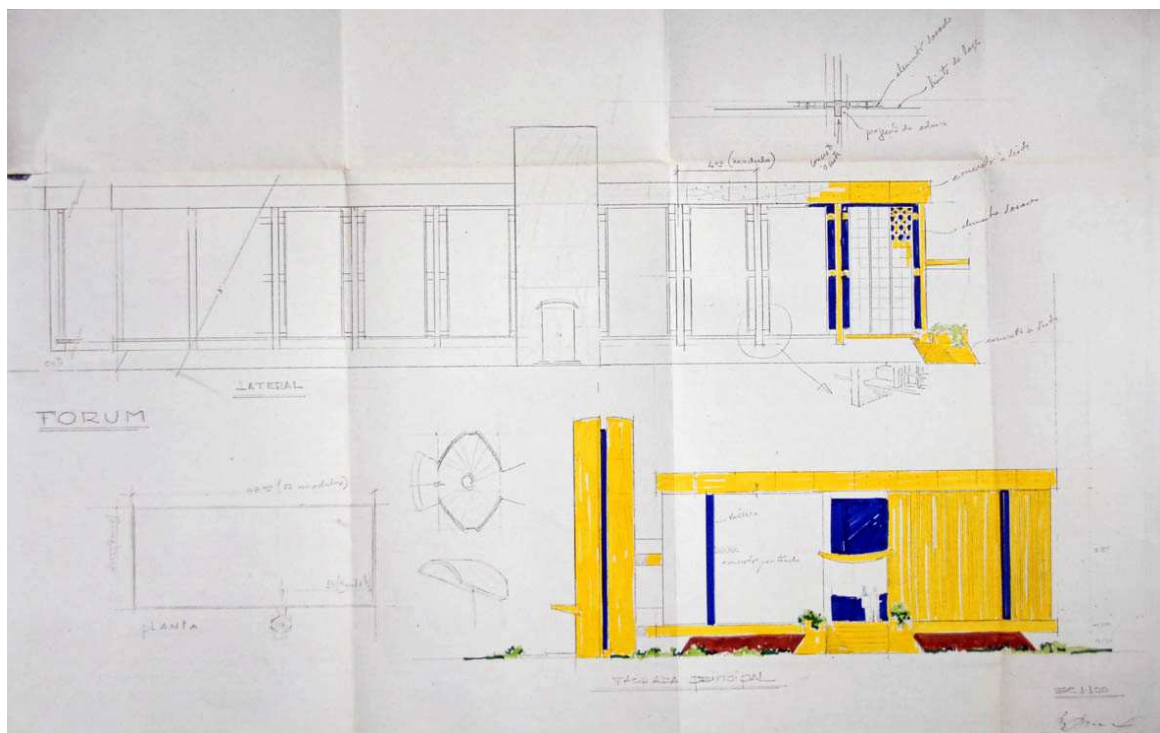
Ante – Projeto Centro Cívico Montes Claros – Fachada Fórum
